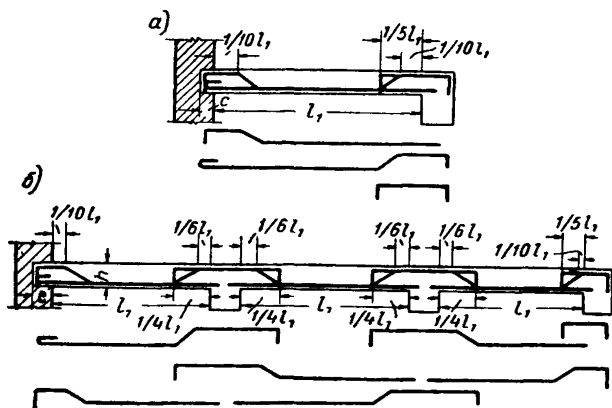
Армирование плит вязаной арматурой при наличии отгибов (при применении для арматуры стали периодического профиля крюки на концах стержней не устраивают)
